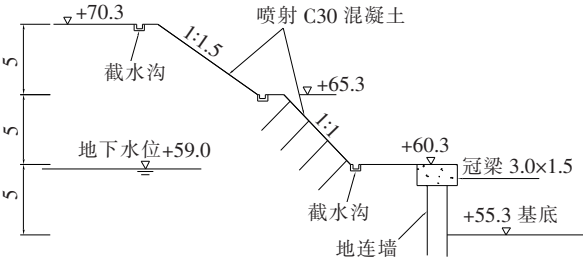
两级放坡开挖+地连墙方案立面示意图(单位:m)
